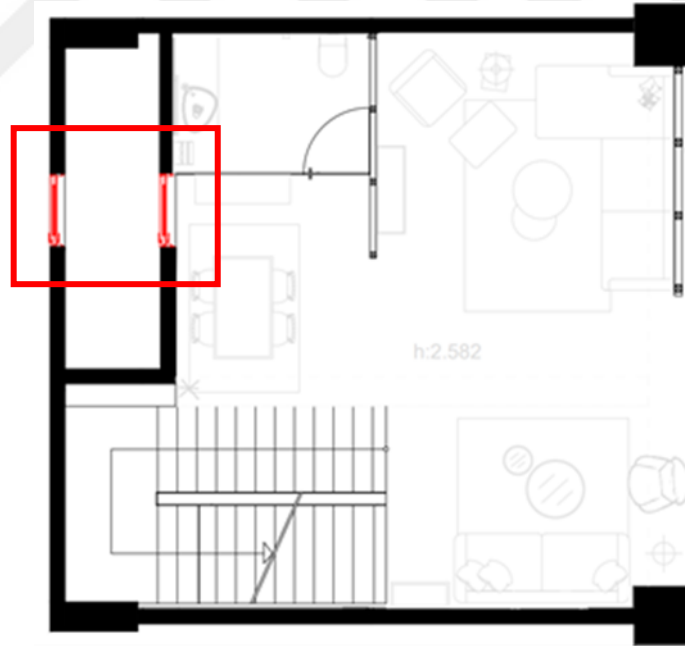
Vivense Beylikdüzü mağazası 2. kat tavan planı
